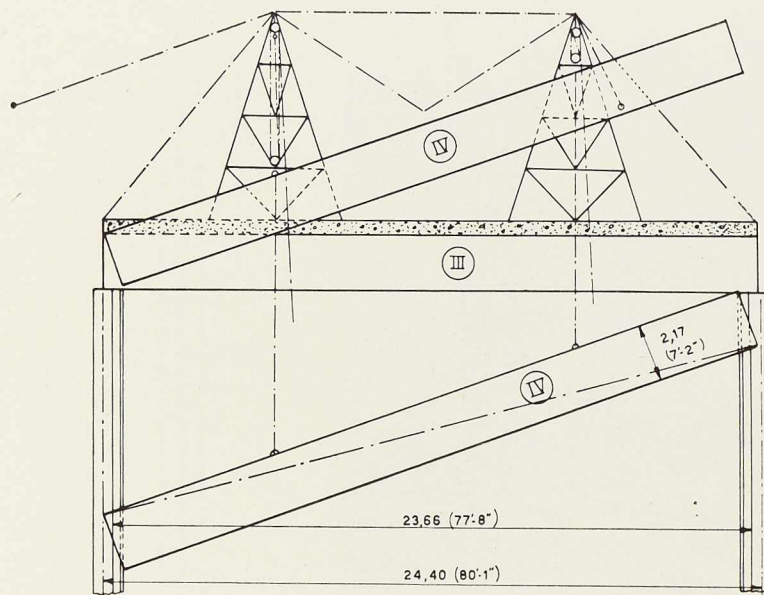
Schéma montrant le dispositif de mise en place des poutres.
